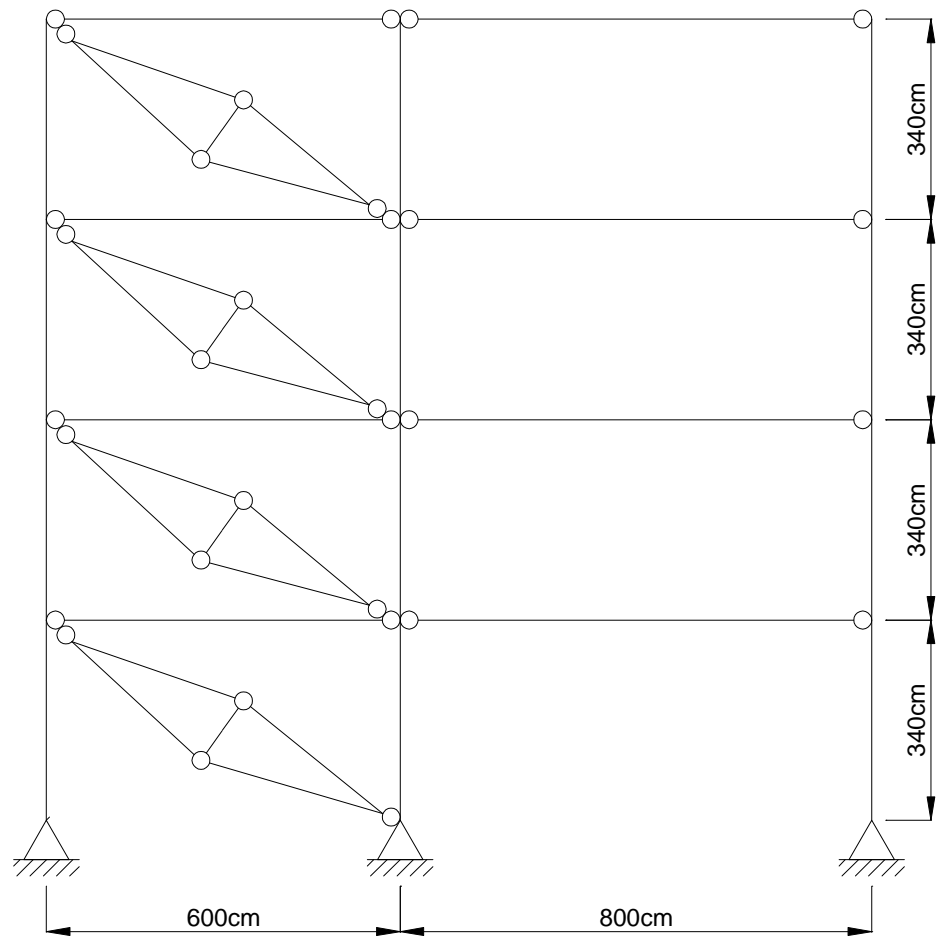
Tipologia utilizada no pórtico plano contraventado por painéis de alvenaria do caso A2.
